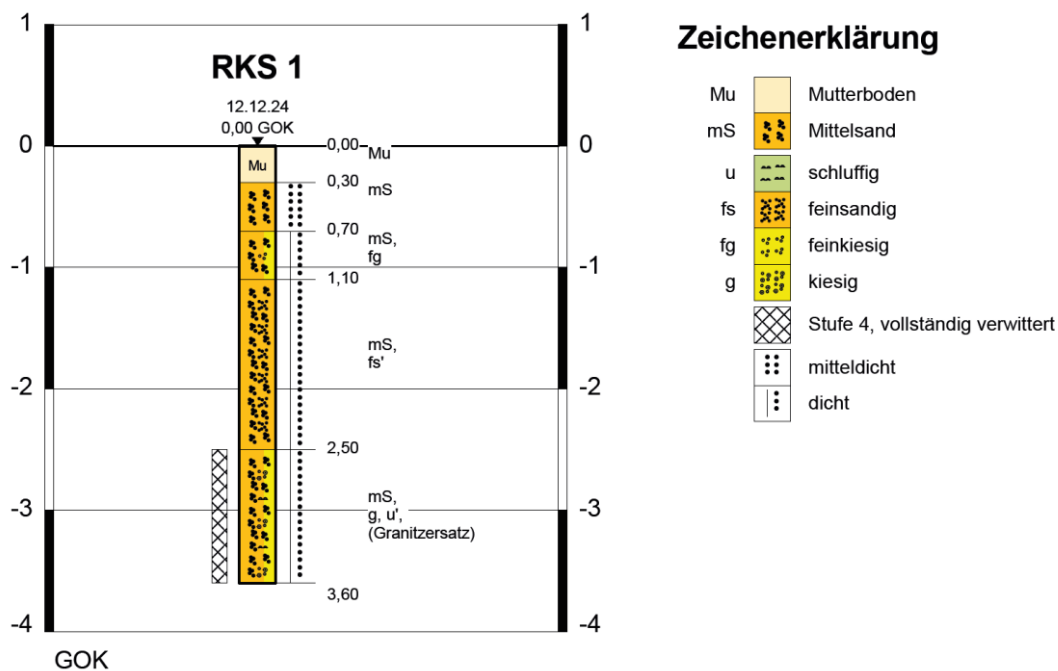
Bodenprofil, Rammkernsondierung; Anlage-Nr. 2 des Prüfberichts zum Versickerungsversuch, Erdbaulaboratorium Dresden
